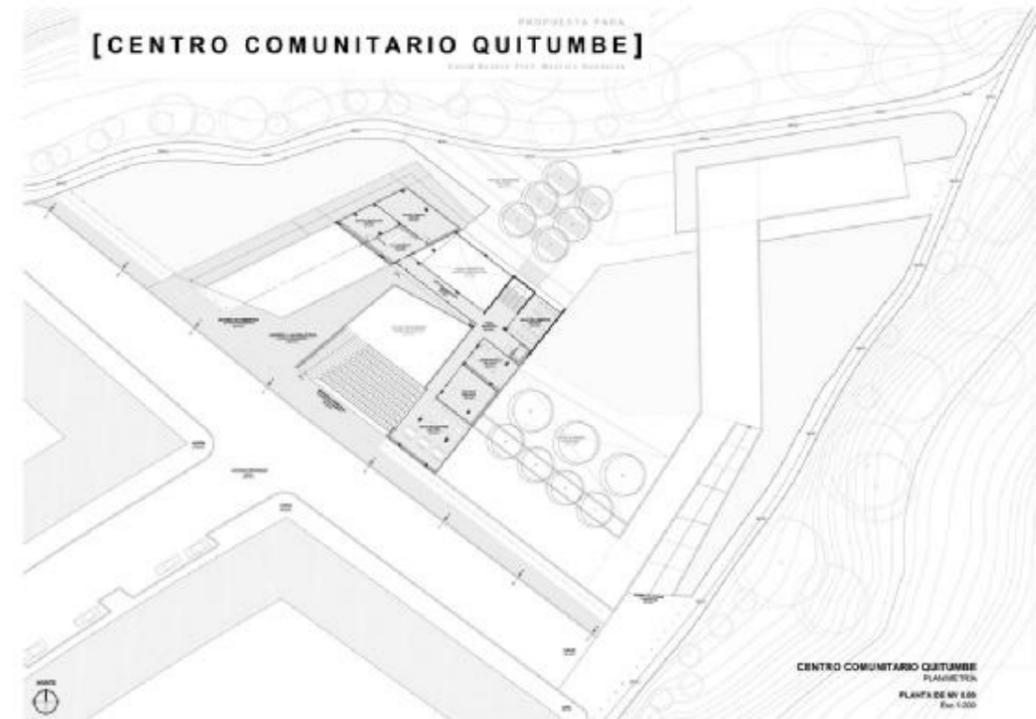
Planos arquitectónicos, planta baja del Centro Comunitario Quitumbe. Fuente: Santos (2005).
